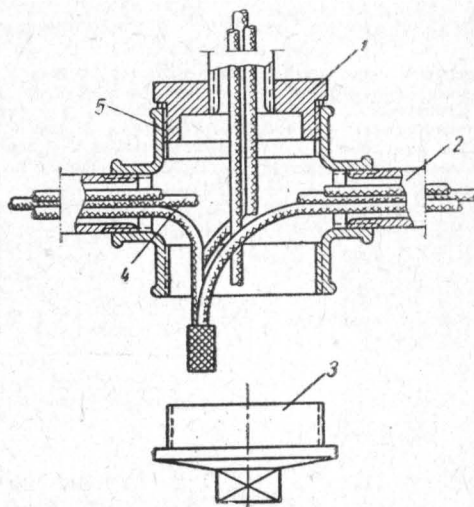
Соединительный фитинг из переходного креста для взрывоопасных помещений всех классов:
